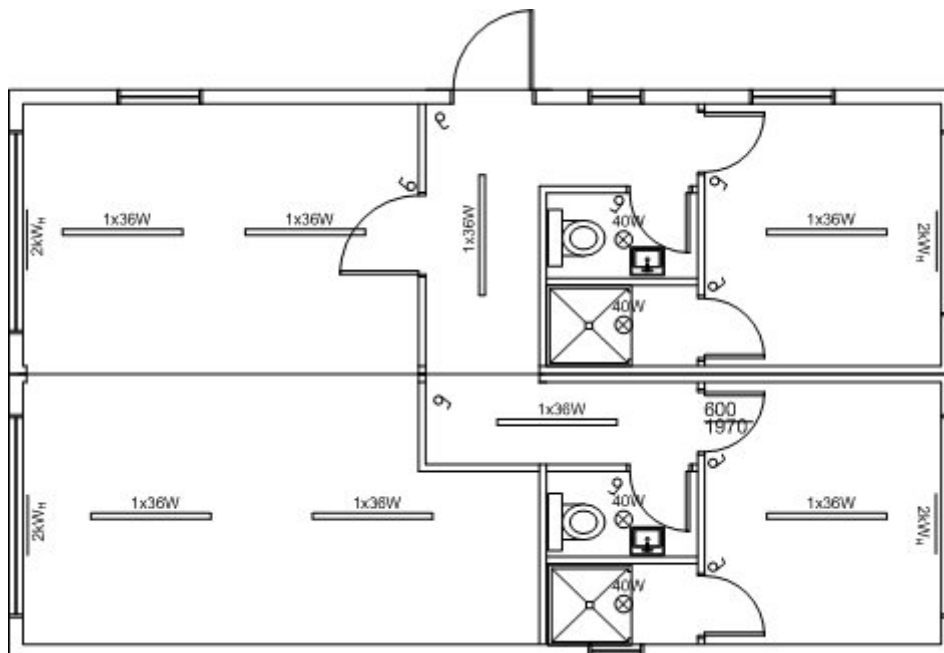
Grundrisszeichnung Aufstockung HtK
